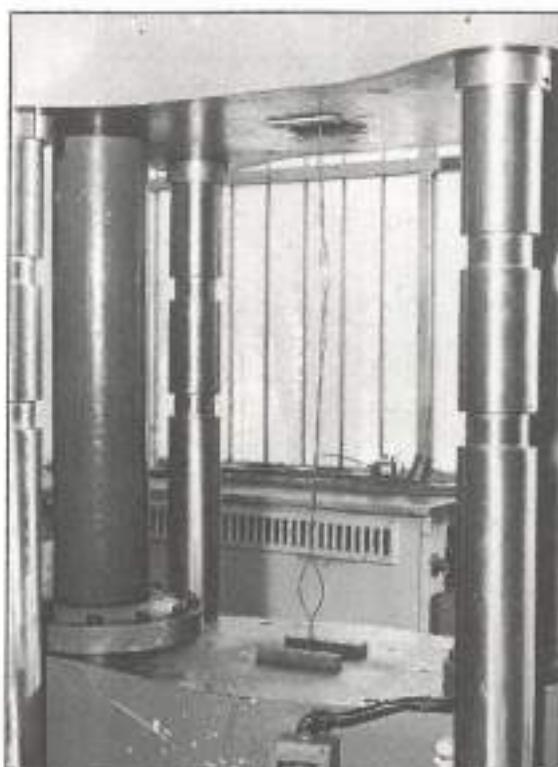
Ensayo de tracción de torzal bifilar de pretensado.
